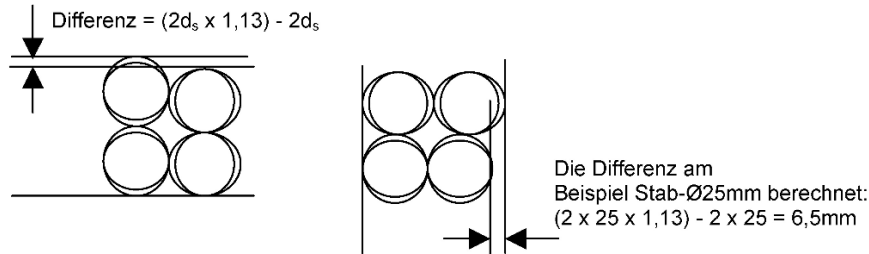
Varianten des Übereinander- und Nebeneinanderlegens von Betonstäben im Maßvergleich
